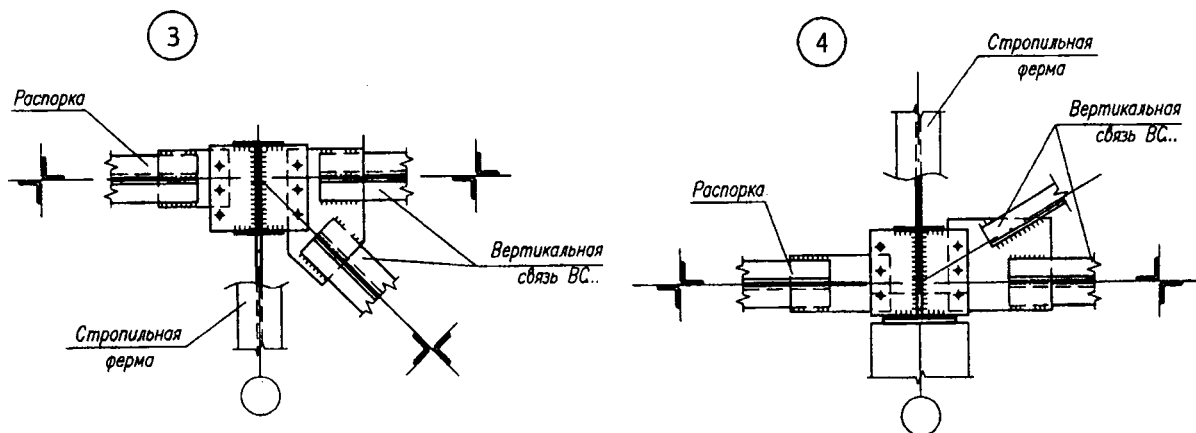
Узлы крепления вертикальных связей к поясам стропильных ферм
